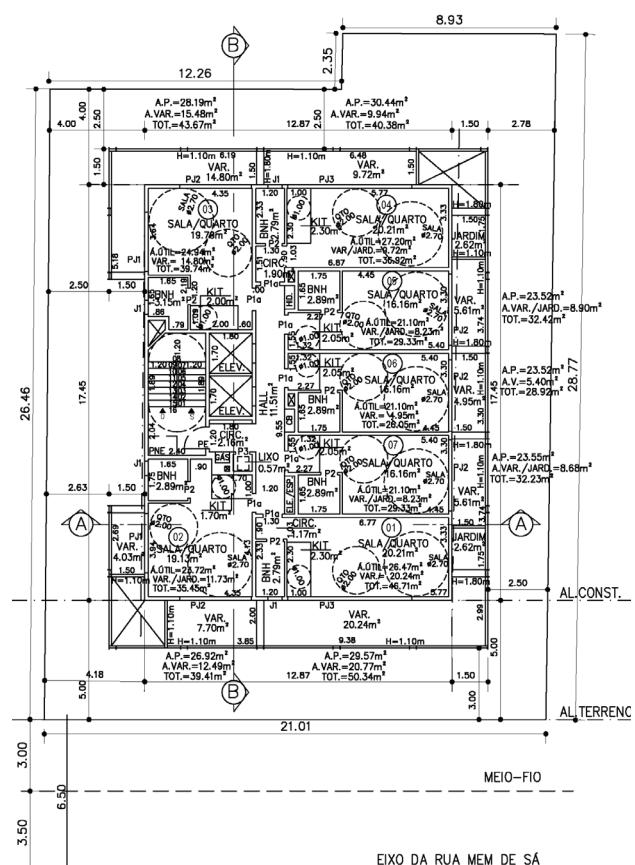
Pavt. Tipo – 9º pavimento – Fonte: Projeto Legal
